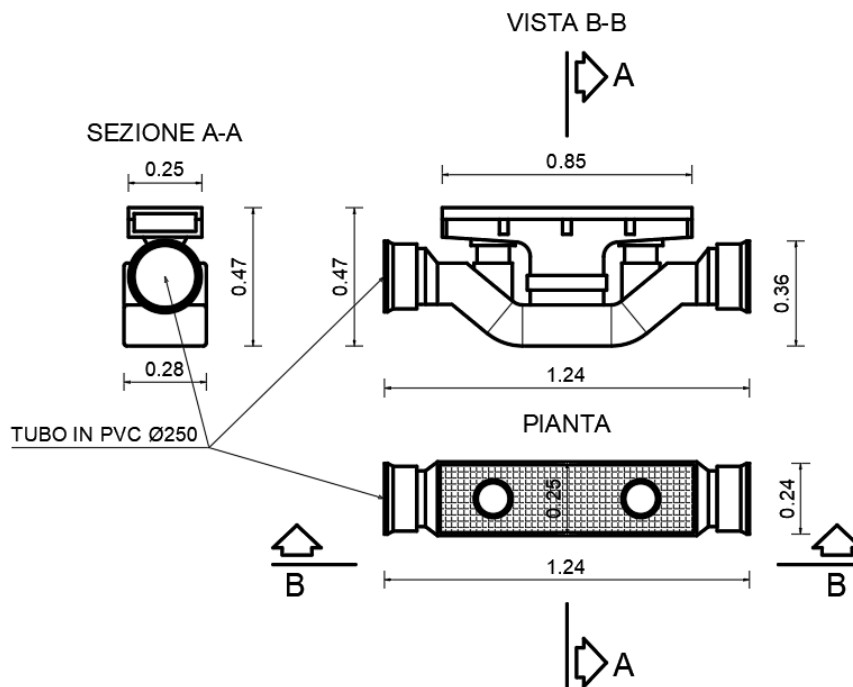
Sezioni tipo pozzetto sifonato.
